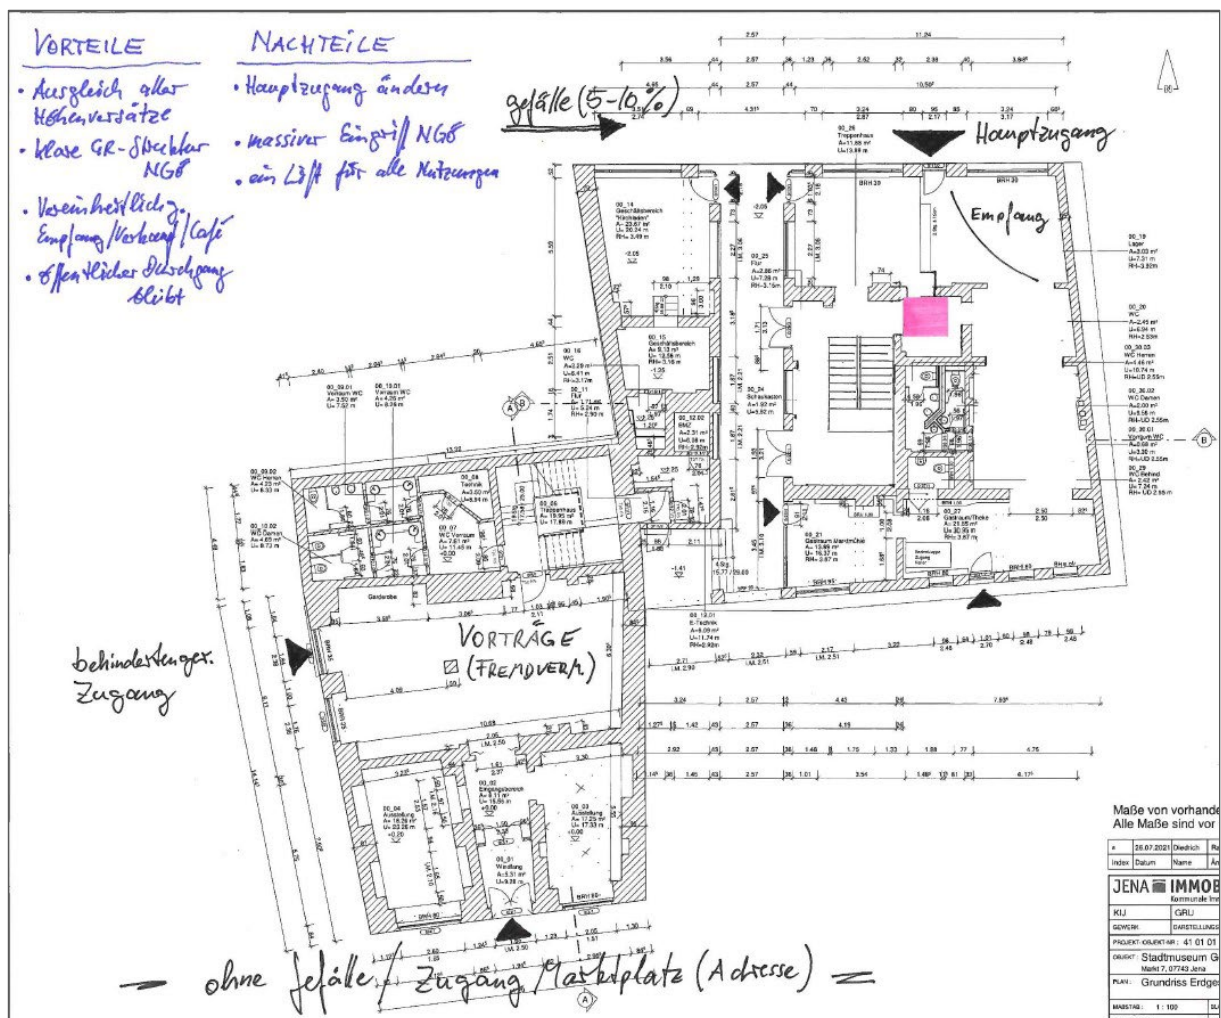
Grundriss Erdgeschoss, Positionierung Aufzug und Eingang zum Gebäude, Variante Lift Ost; Verfasser Wolfgang Winkler, Kommunale Immobilien Jena
